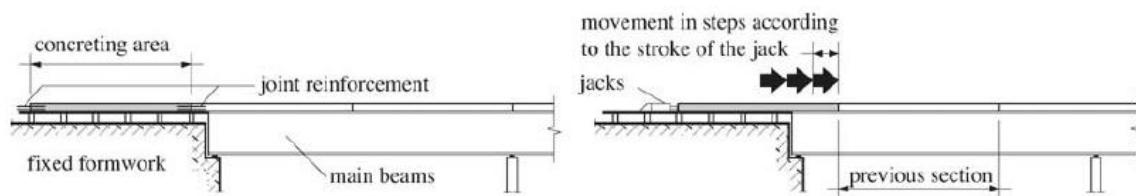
pořadí betonování jednotlivých úseků při betonáži s jedním vozíkem (7)
